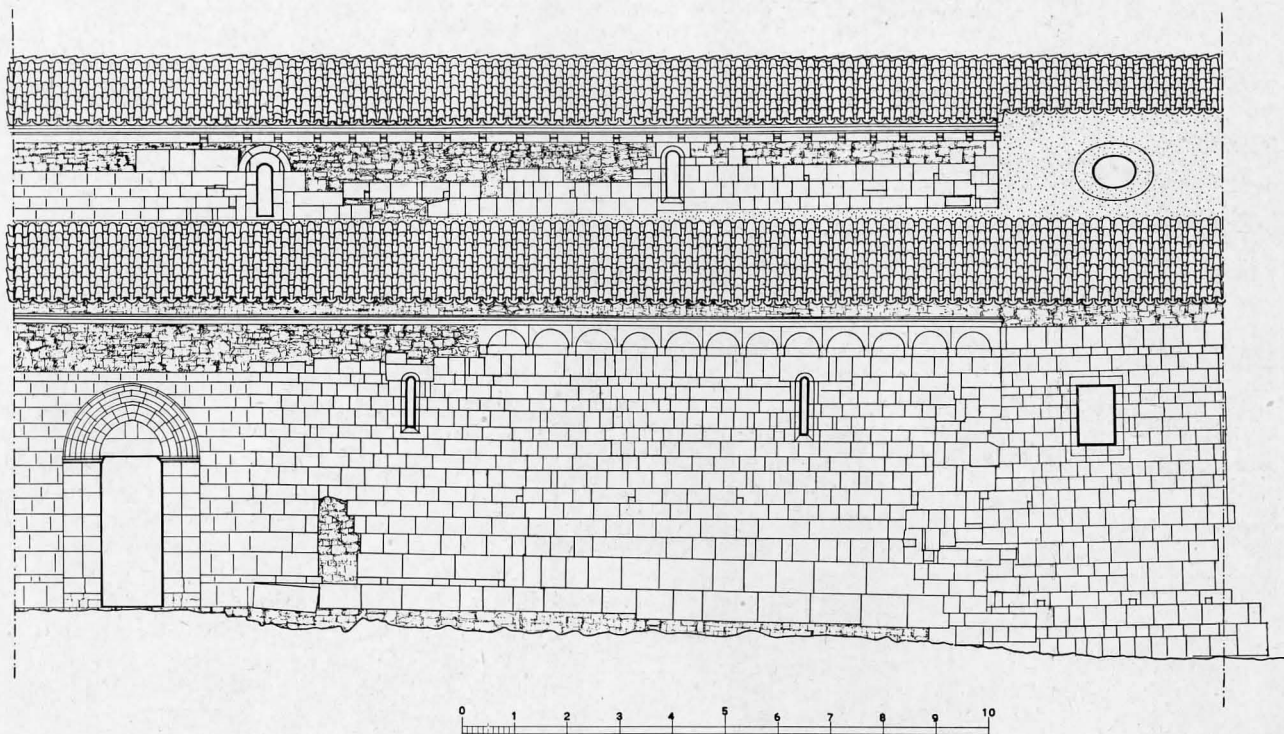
PROSPETTO SUD SENZA IL TARDO CAMPANILE
